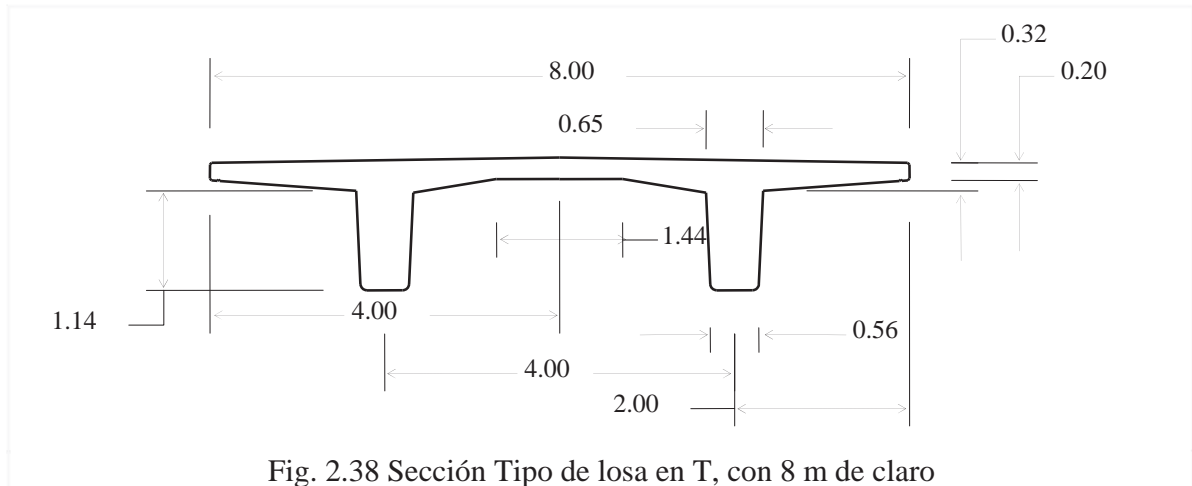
Sección Tipo de losa en T, con 8 m de claro
